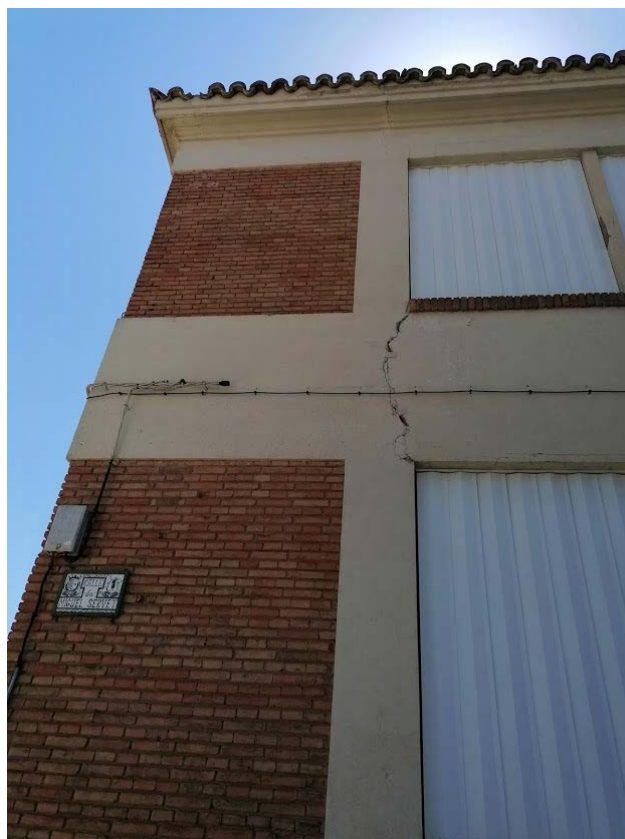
Alzado exterior visto desde la calle Miguel Servet. Se aprecia un grieta sensiblemente vertical que seguramente se debe a que el edificio es muy largo y no dispone de juntas de dilatación.
